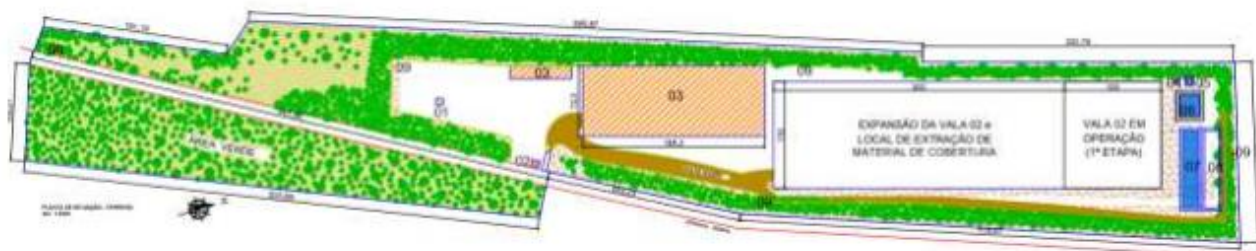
Planta de localização do Aterro Sanitário de Cáceres/MT
